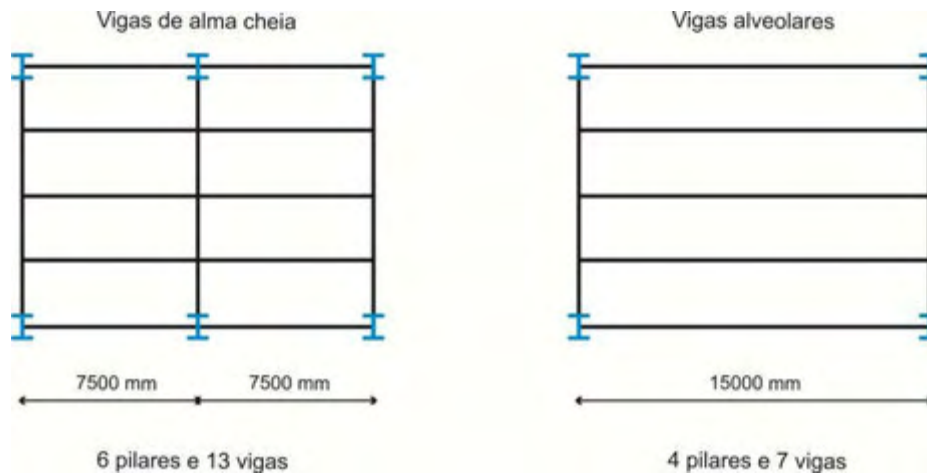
Comparação do número de peças estruturais entre pavimentos com viga de alma cheia e com viga alveolar.
